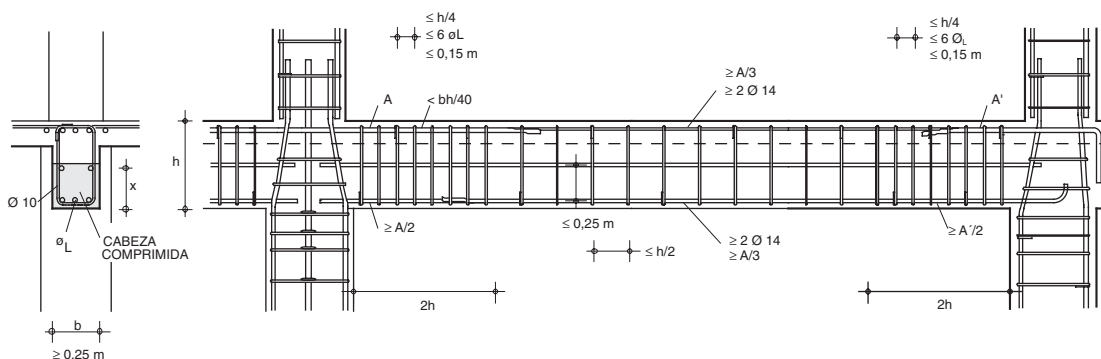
Requisitos de vigas para ductilidad muy alta ($\mu = 4$)
